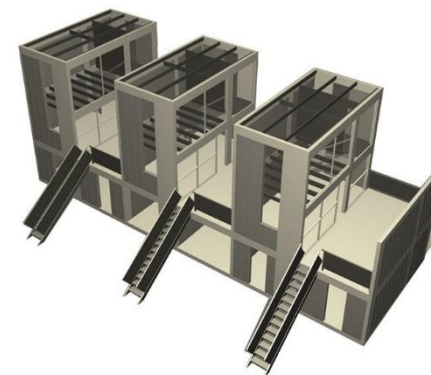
Fase 5: Colocación de estructura de cerramiento, cubierta y entrepiso de segundo nivel.
